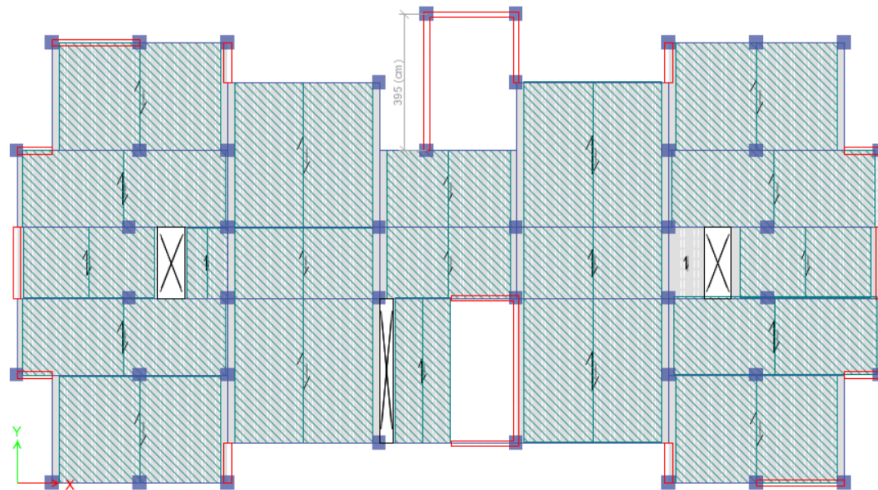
Diseño por franjas en losa aligerada Sistema Dual - Edificio Blesser.
